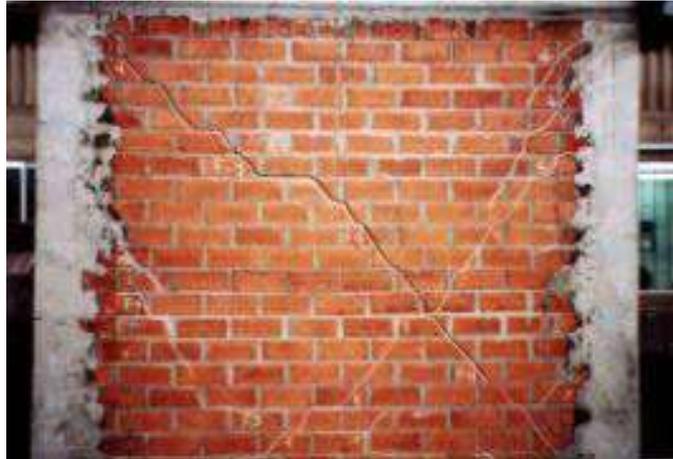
Falla en muros confinado, construido con albañilería hueca.
